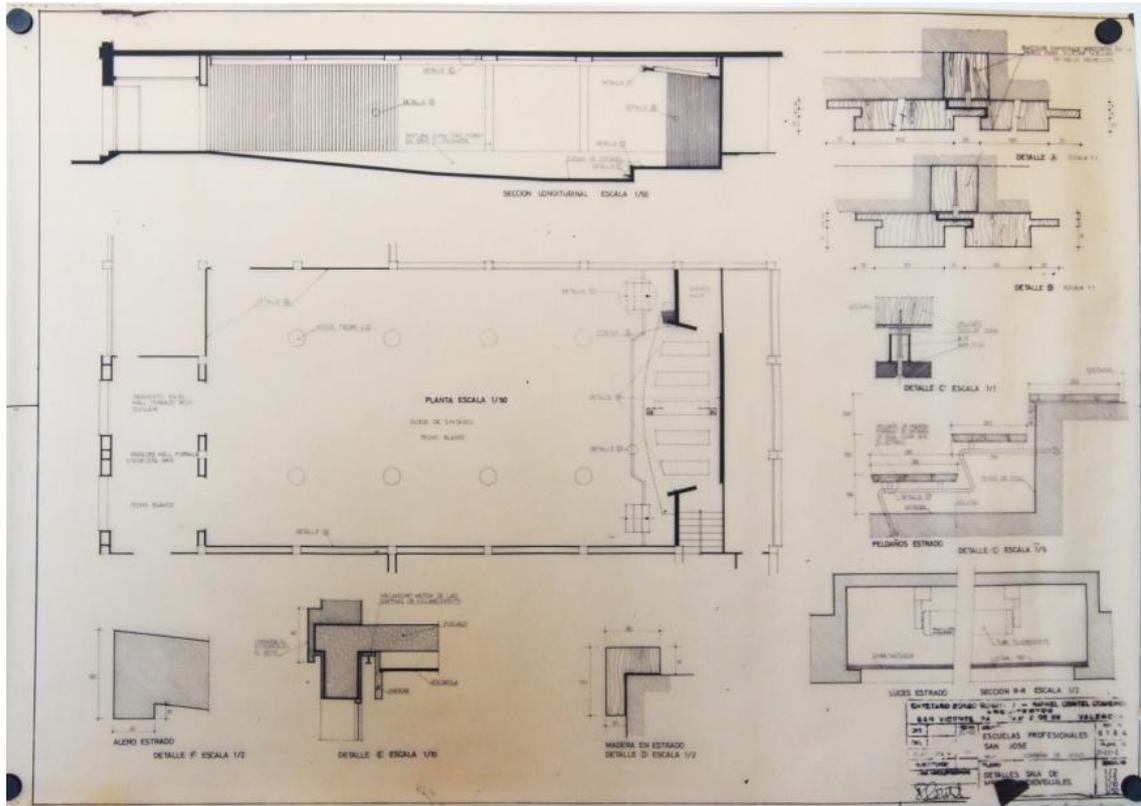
Planta, alzado y sección sala conferencias. *Archivo Escuelas San José.
